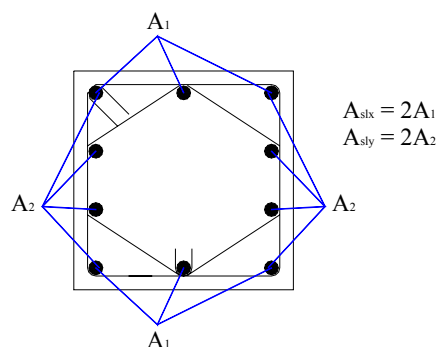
Definição da armadura longitudinal dos pilares.
